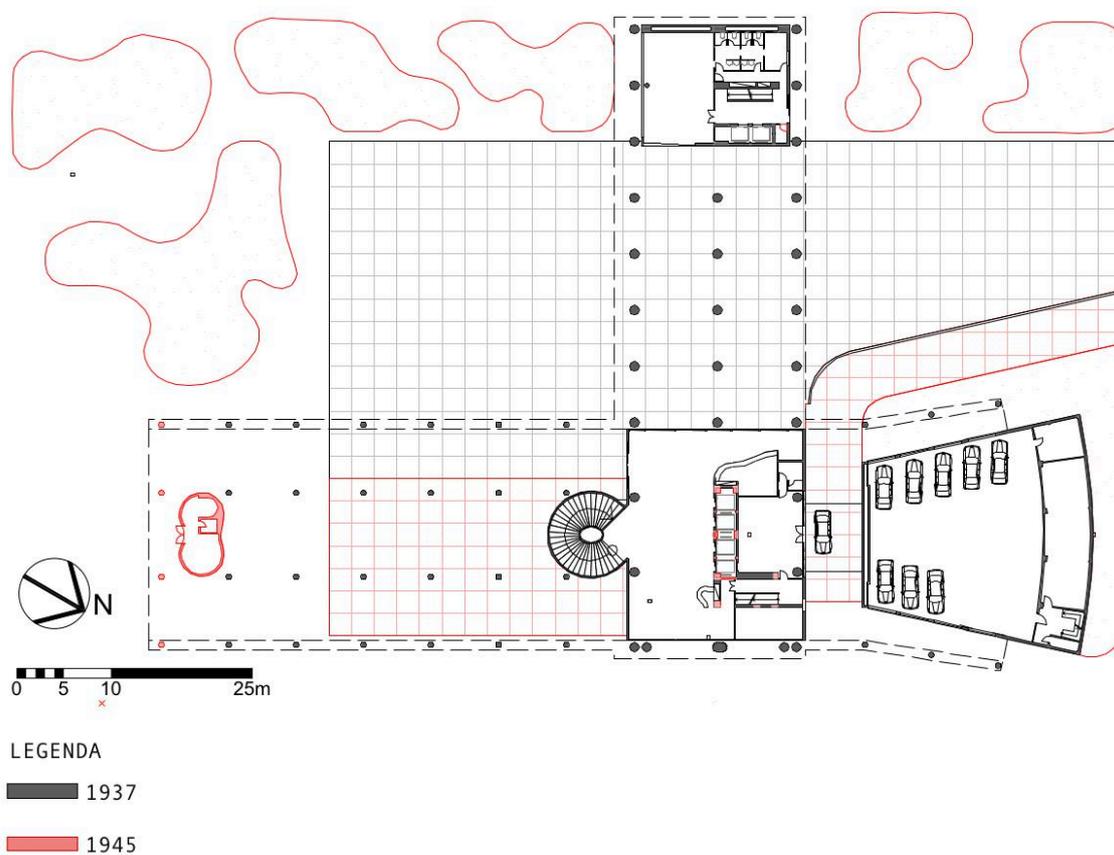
Planta 1937 -1945, marcando as principais modificações durante a construção
